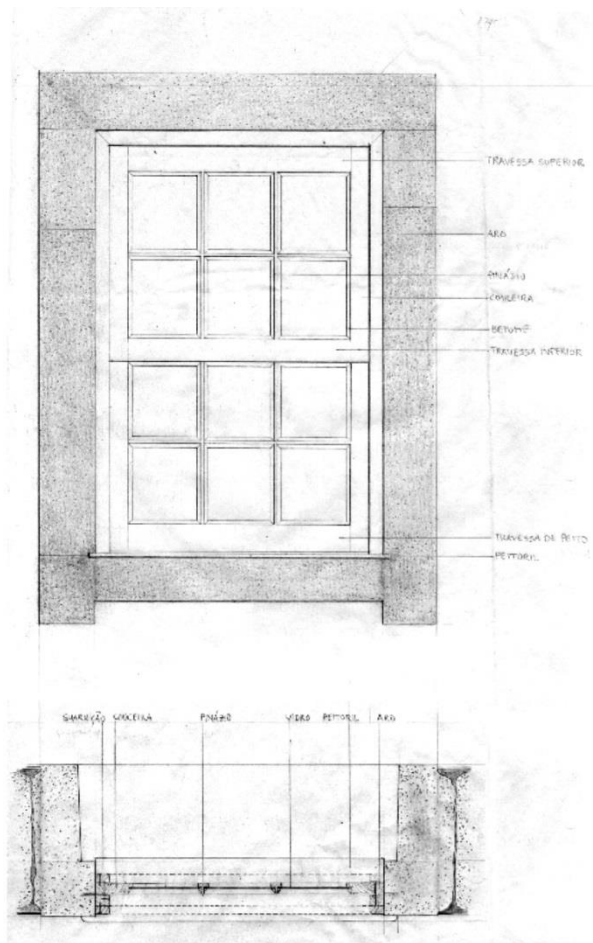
Alçado e planta de janela de guilhotina.
